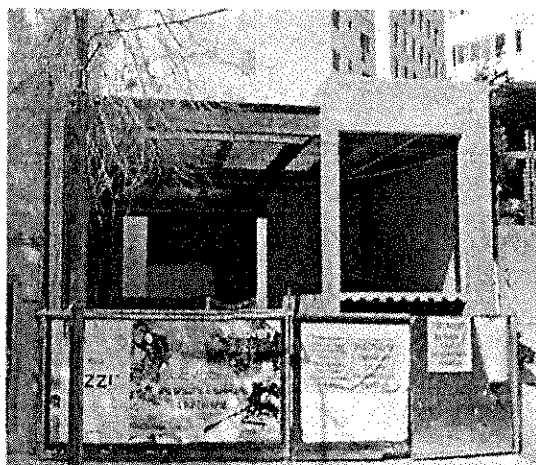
Fuente Street view de google maps de enero 2015. Se aprecia el desplante de un inmueble en 1 nivel y semisótano, a base de estructura metálica a base de vigas de acero, con entrepiso de losacero.
